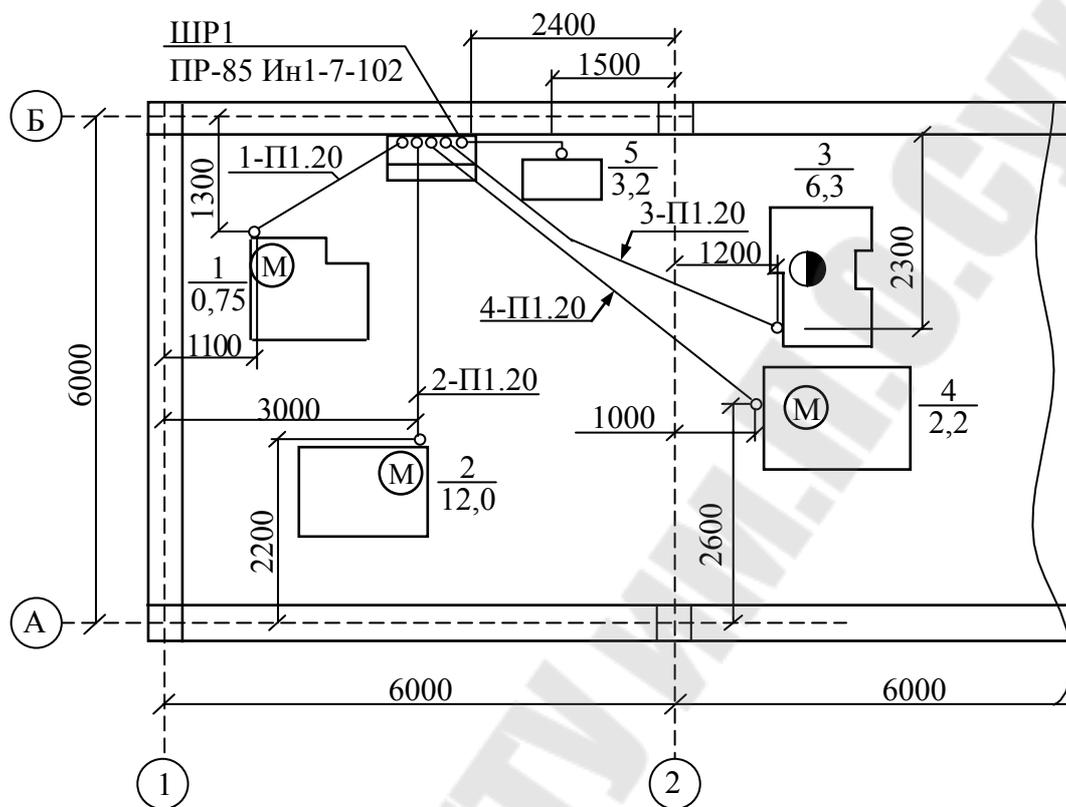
Фрагмент плана цеха с силовой сетью
